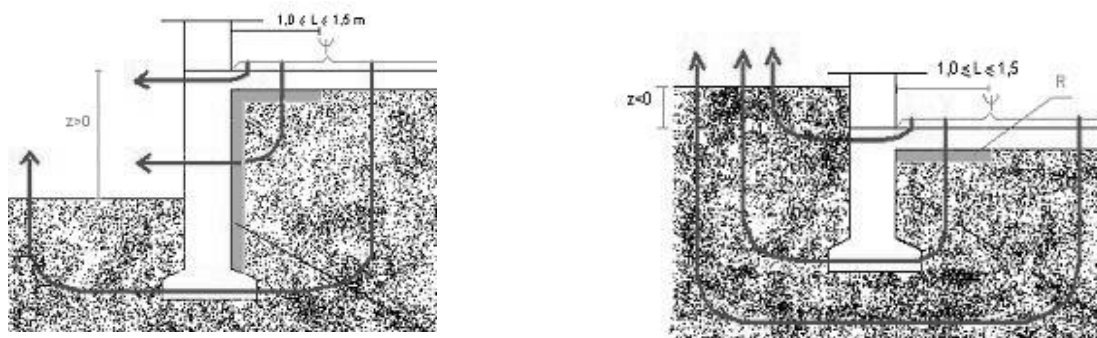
Pavimentos em contacto com o terreno com isolante térmico perimetral
